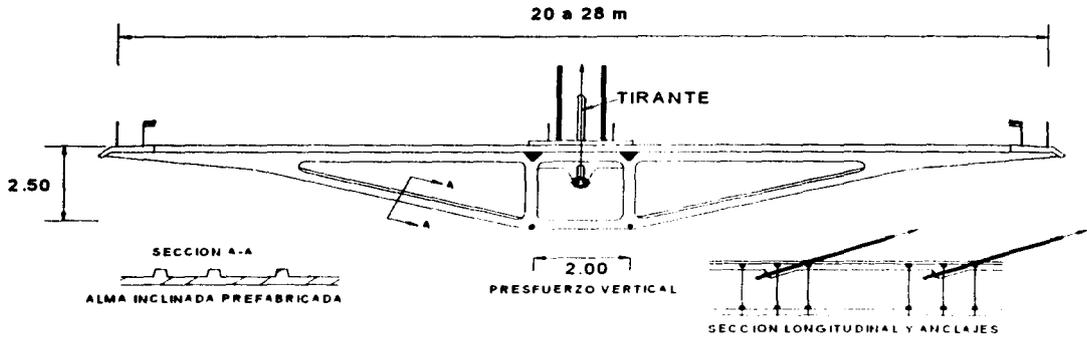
11 Sección transversal de un tablero esbelto con el anclaje de los cables en el centro de calzada
